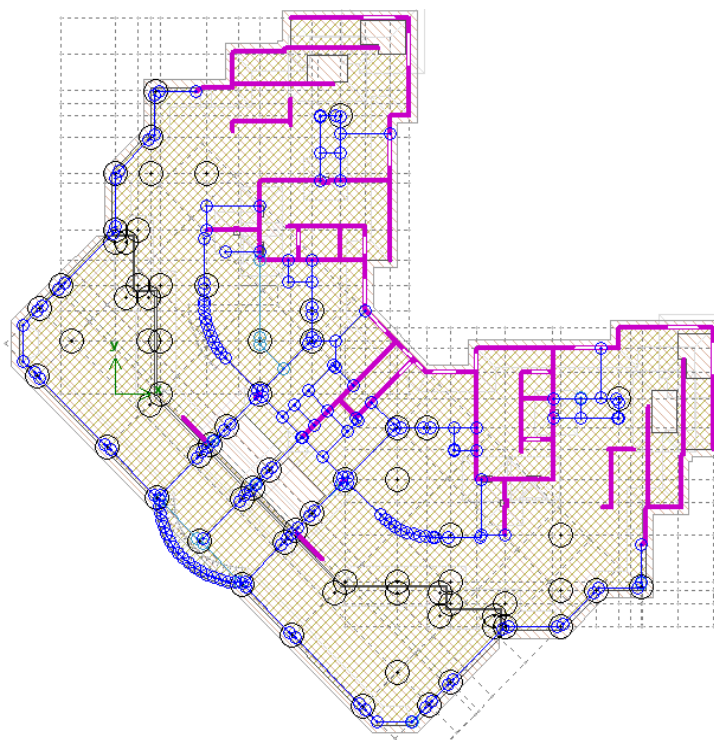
Розрахункова схема підвалу будівлі
